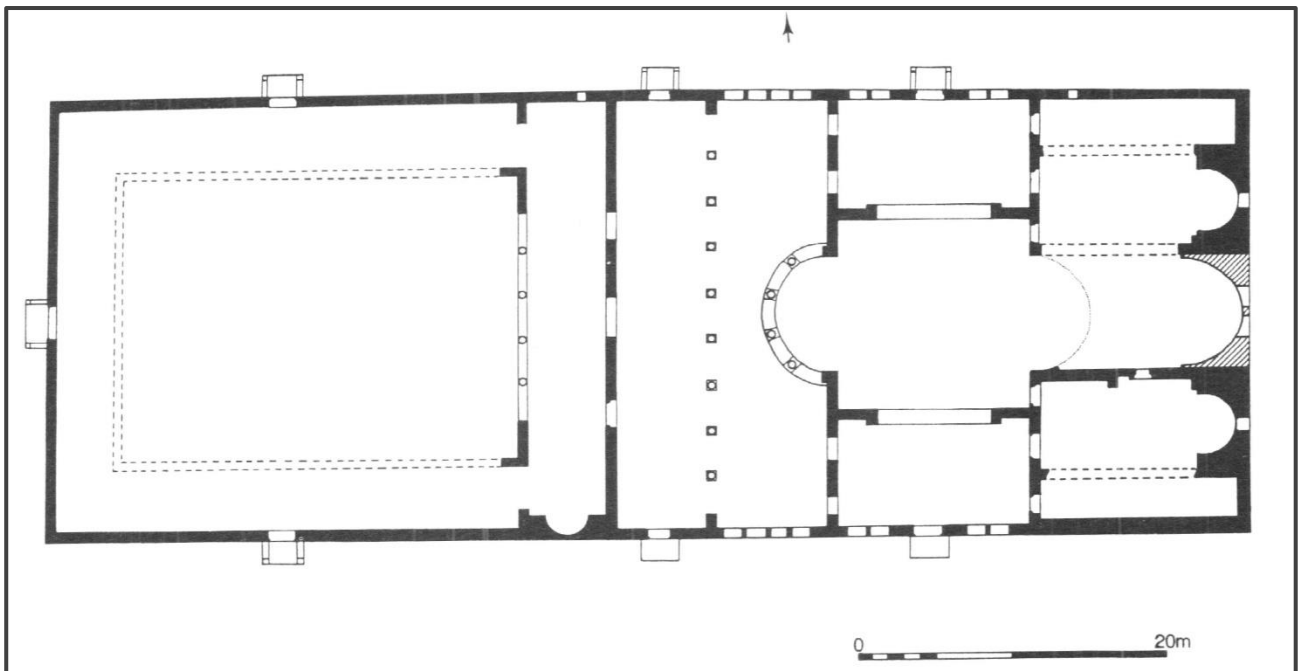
Korykos 1. Pianta del complesso (Hill 1996, Pianta 19).
